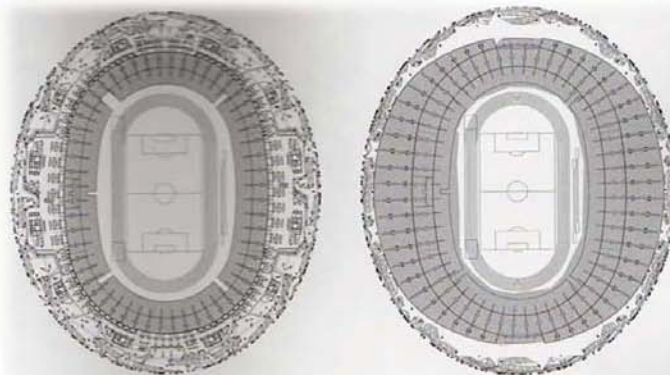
Plantas arquitectónicas, la de la izquierda muestra la planta baja o de acceso, y la de la derecha el de graderías totales.
